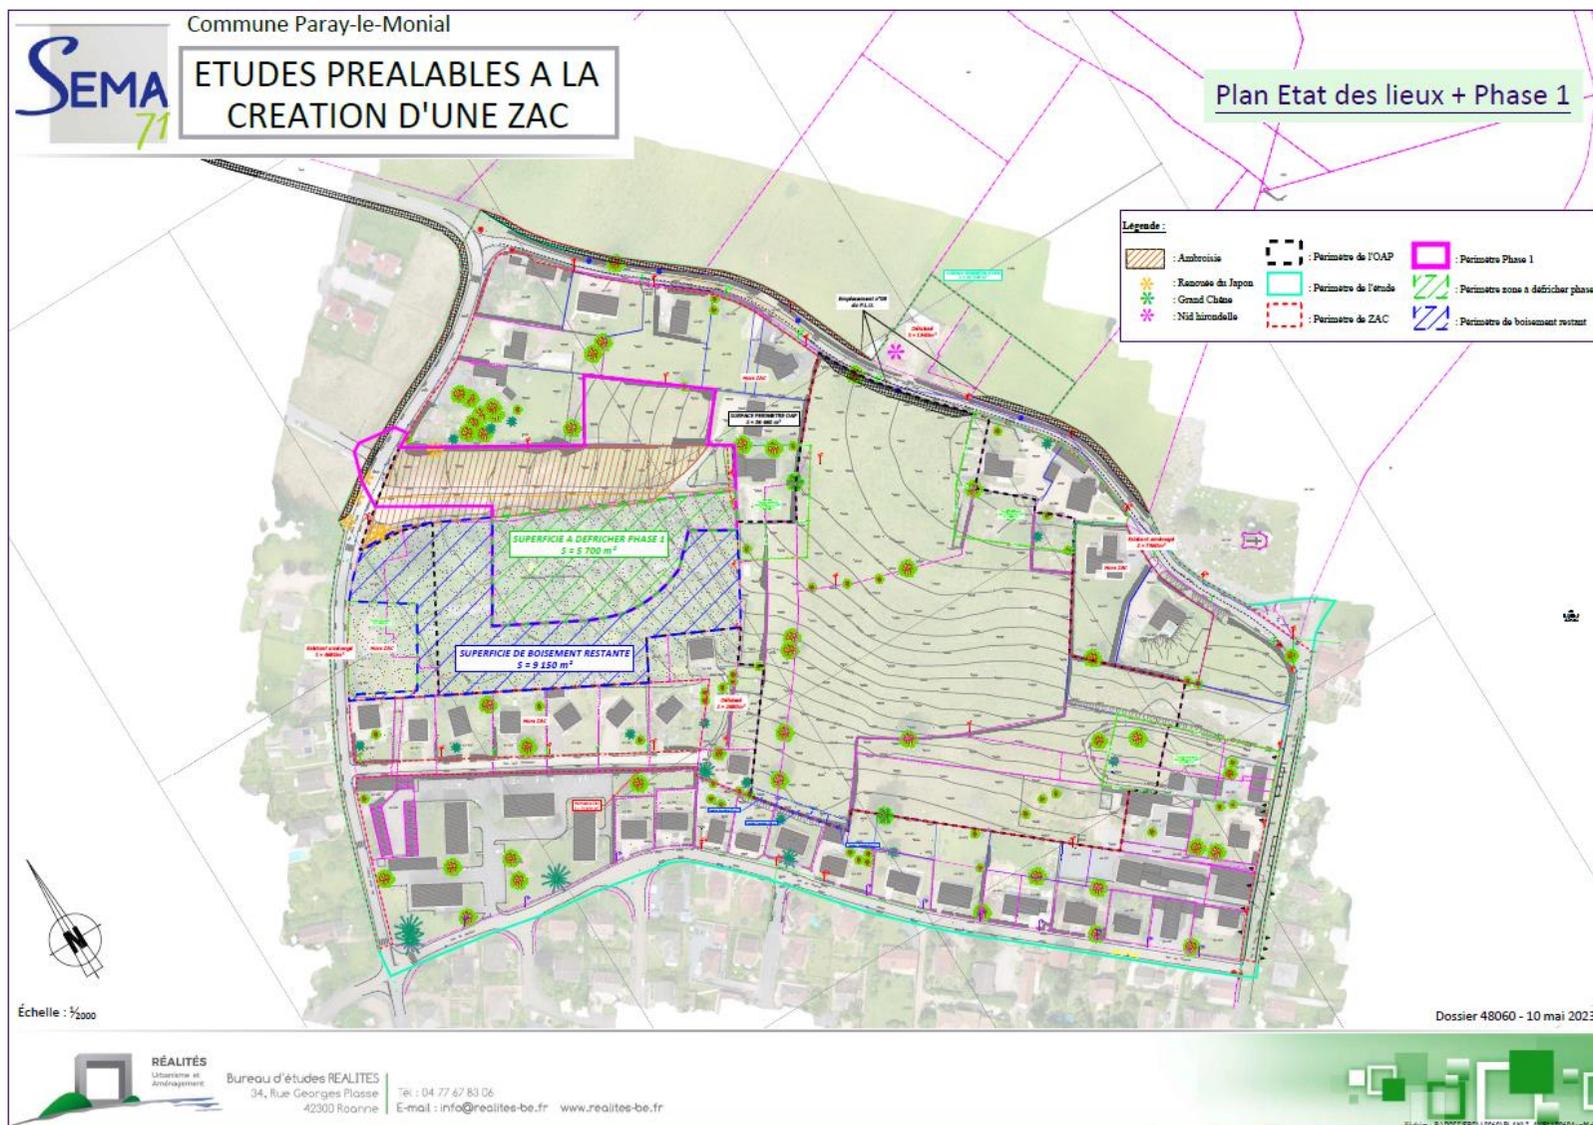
Phasage des travaux laissant une zone refuge dans le boisement de Robiniers faux-acacias
